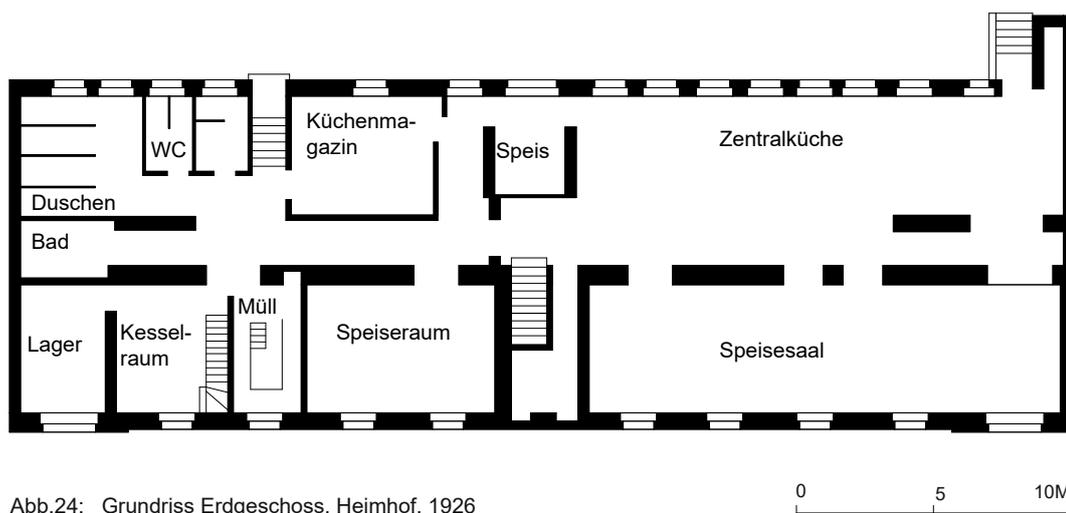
Grundriss Erdgeschoss, Heimhof, 1926
